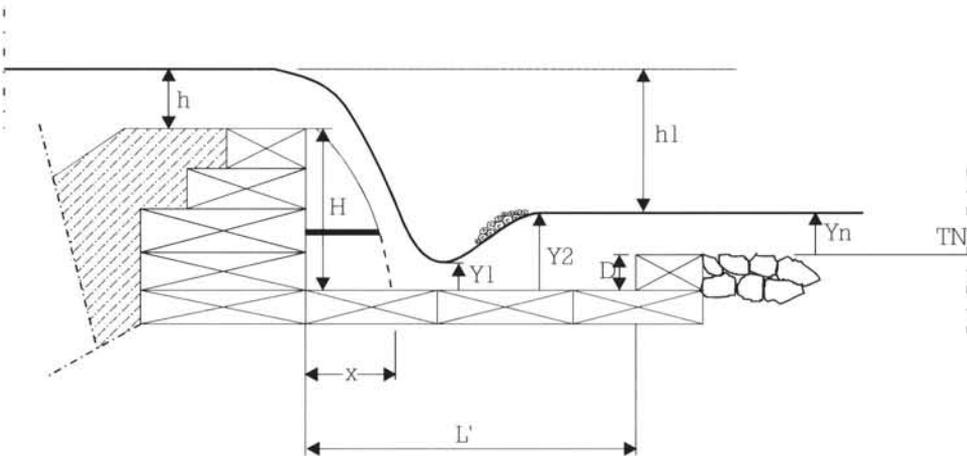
Dimensionnement d'un bassin revêtu.
